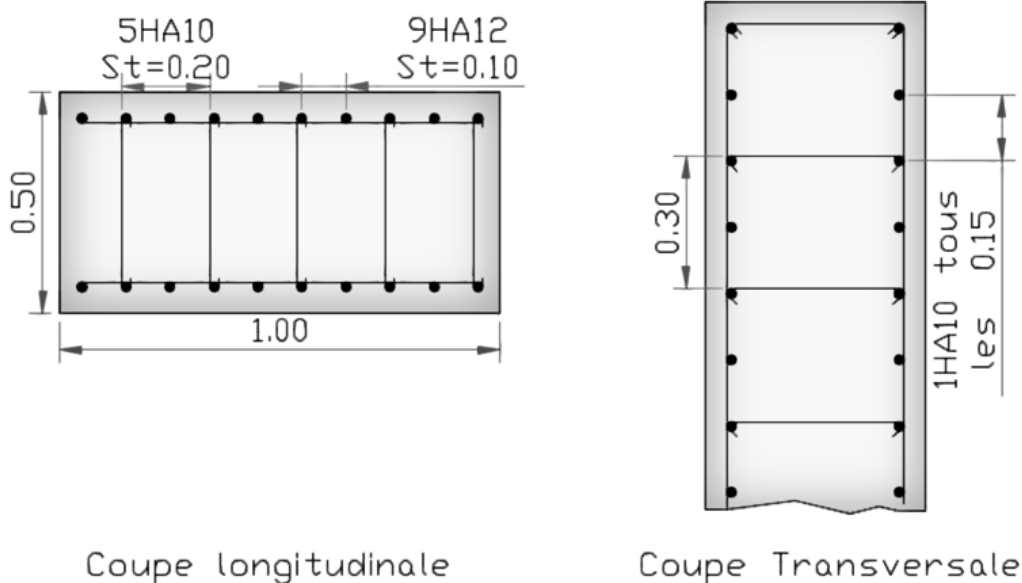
Schéma de ferrailage (en plan) du mur garde grève
